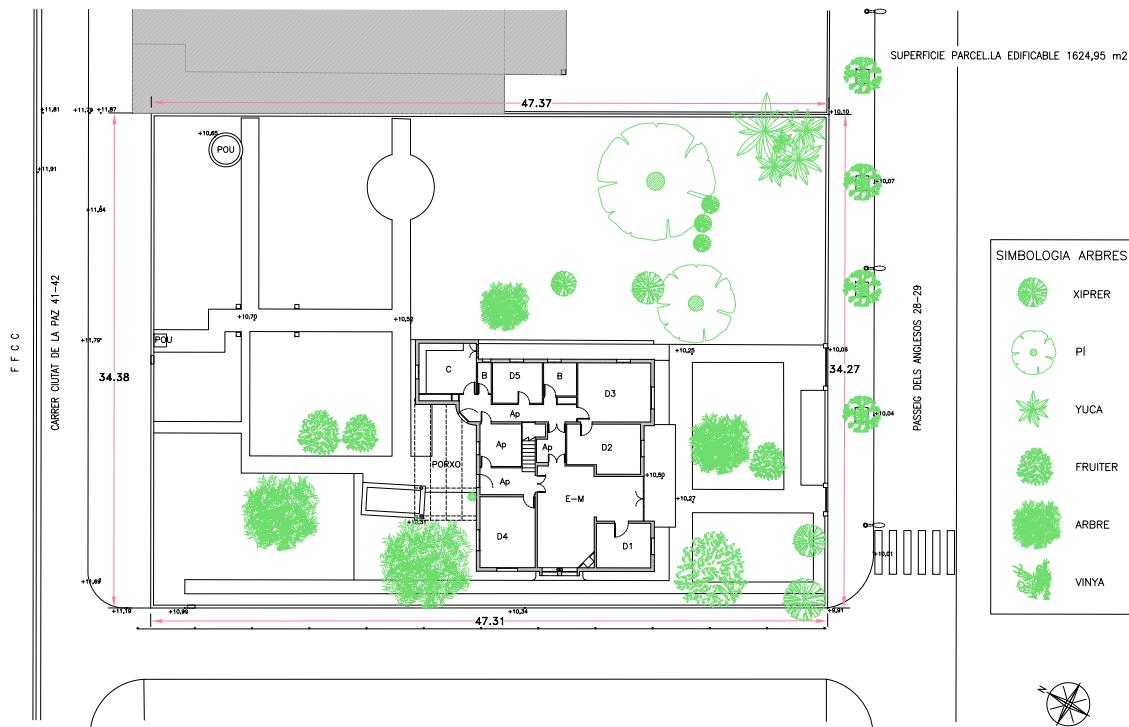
Distribució de l'edificació en planta baixa i la seva relació amb els espais enjardinats propers
